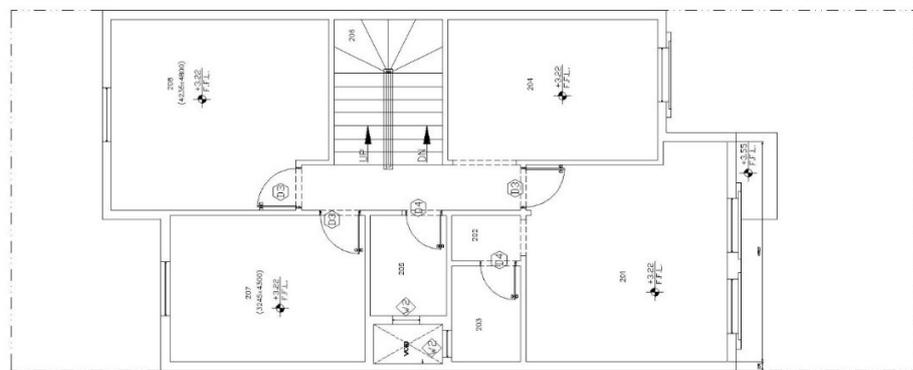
Planta alta arquitectónica. Proyecto Al Qara.
